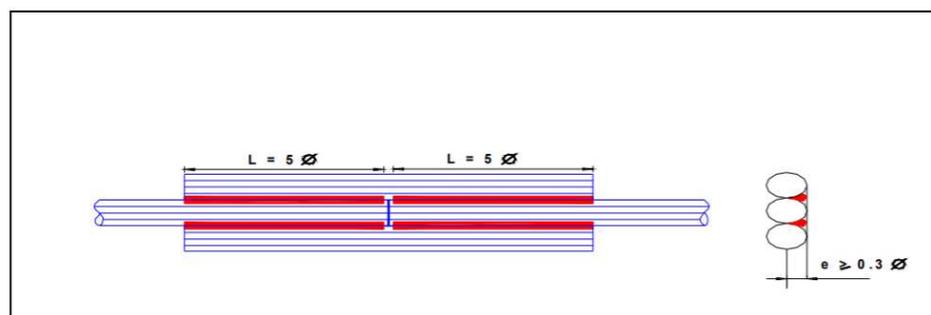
Refuerzo del acero con soldadura filete de un lado (Do Lago 1997)
